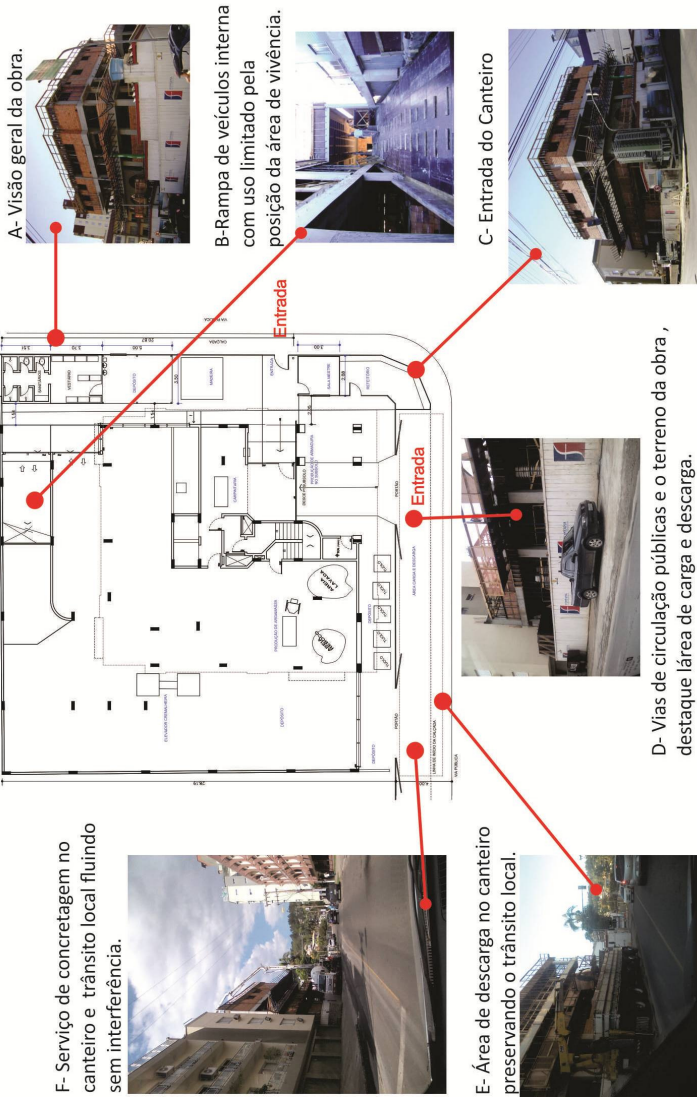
Ambiente Construído do canteiro do estudo C. A Foto B é de autoria da Construtora do empreendimento.
